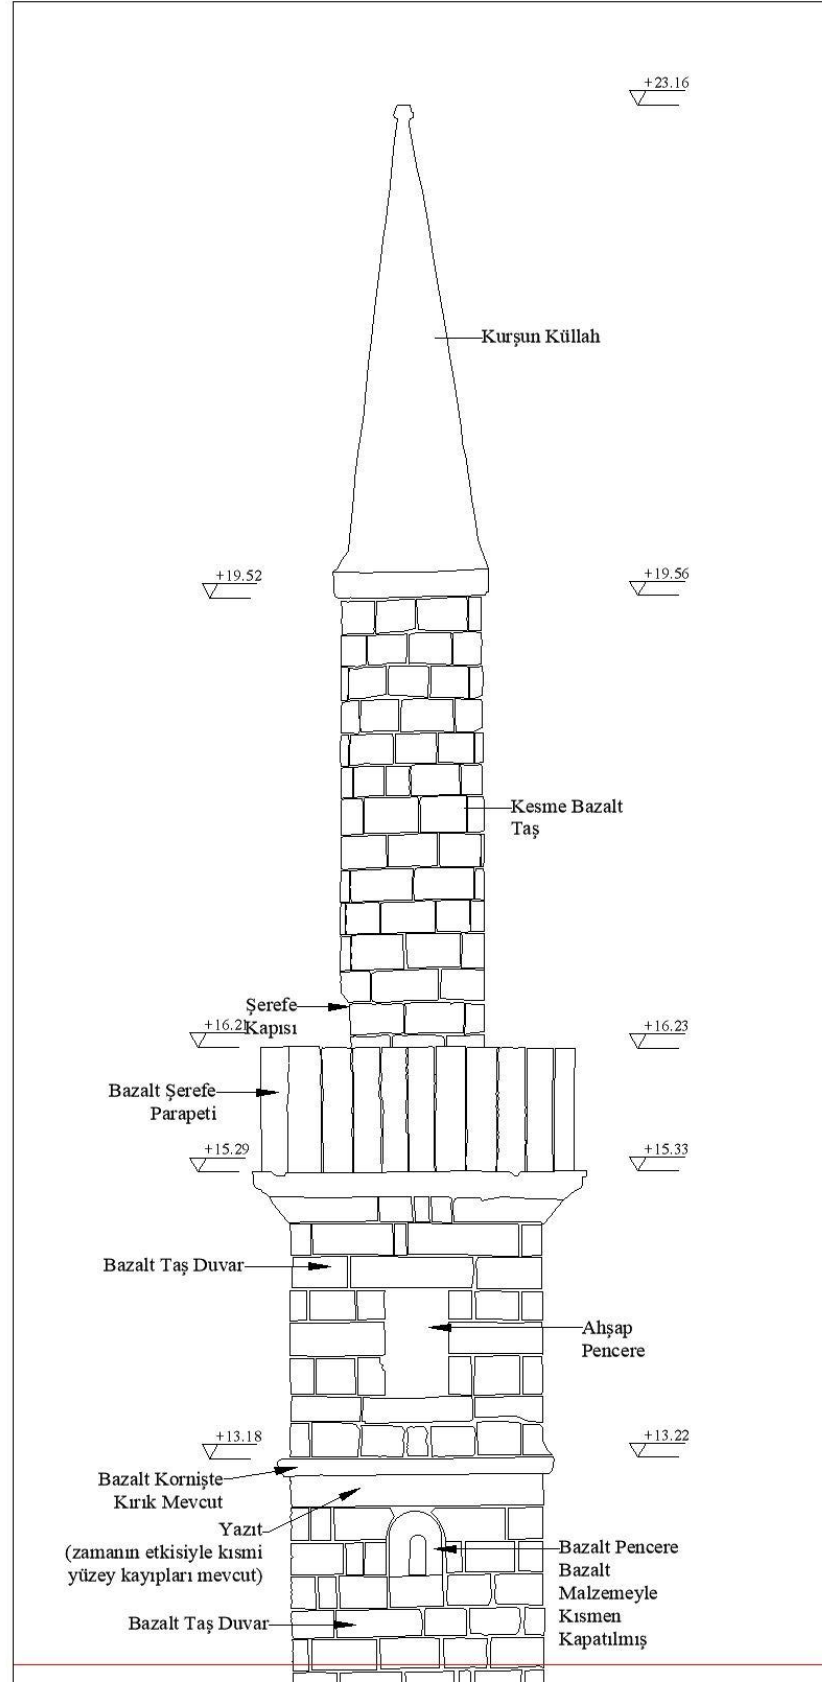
Güney cephesinin detaylı çizimi-2.
